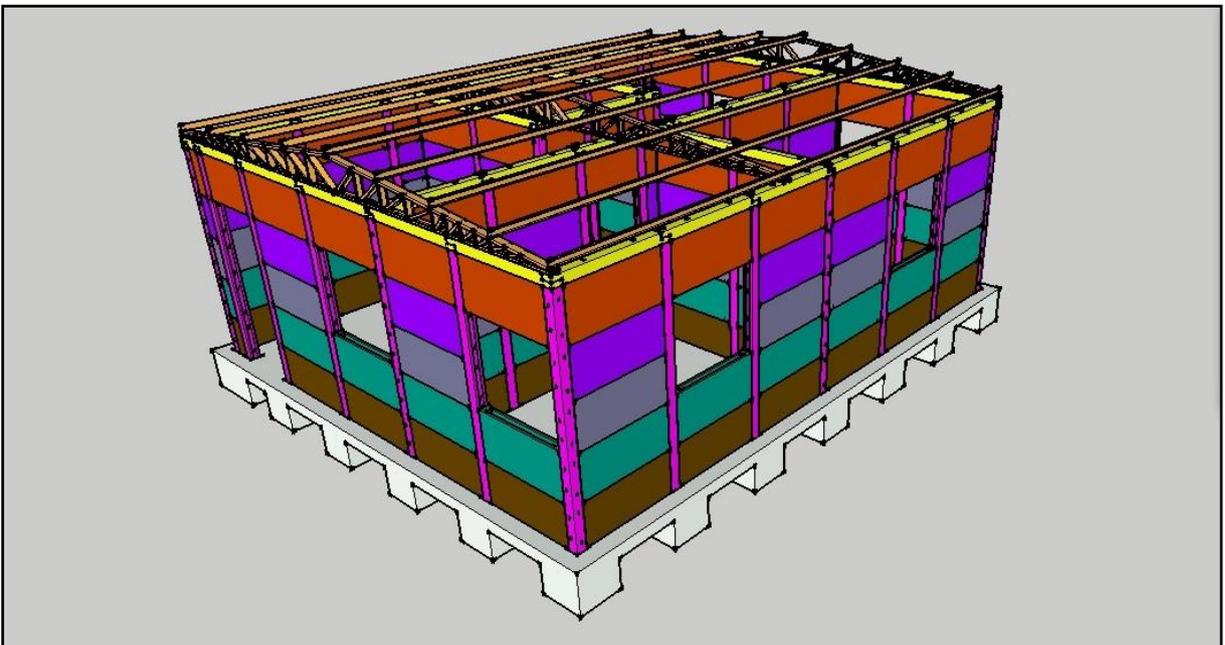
vigas pré-moldadas encaixadas nos pilares através dos pinos
